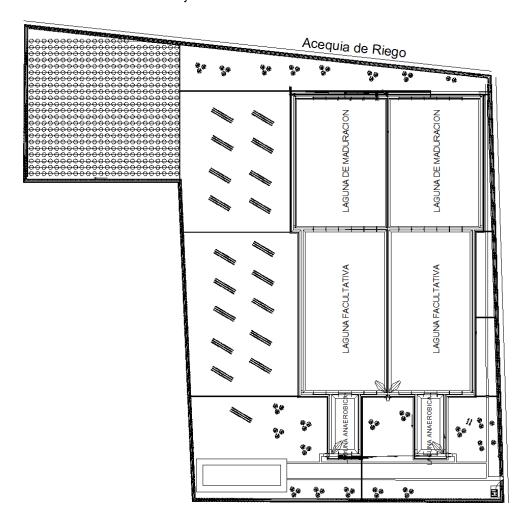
Planta de tratamiento mediante lagunas propuesta
